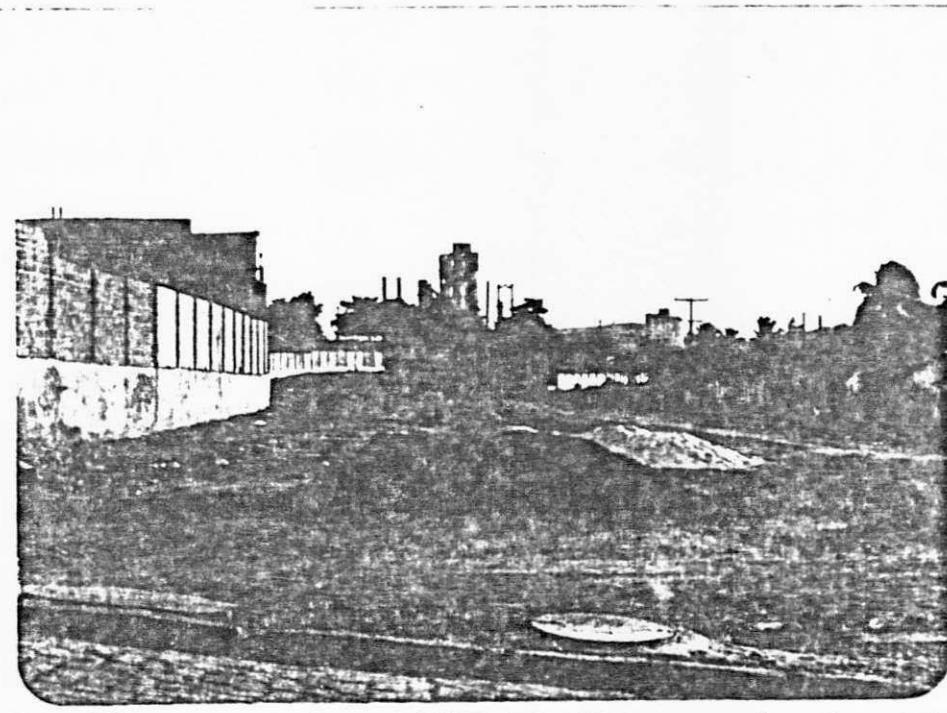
Vista da área já desapropriada da MA TARAZZO para a execução do prolongamento da Avenida Sanhauá, até a Rua Índio Piragibe.
